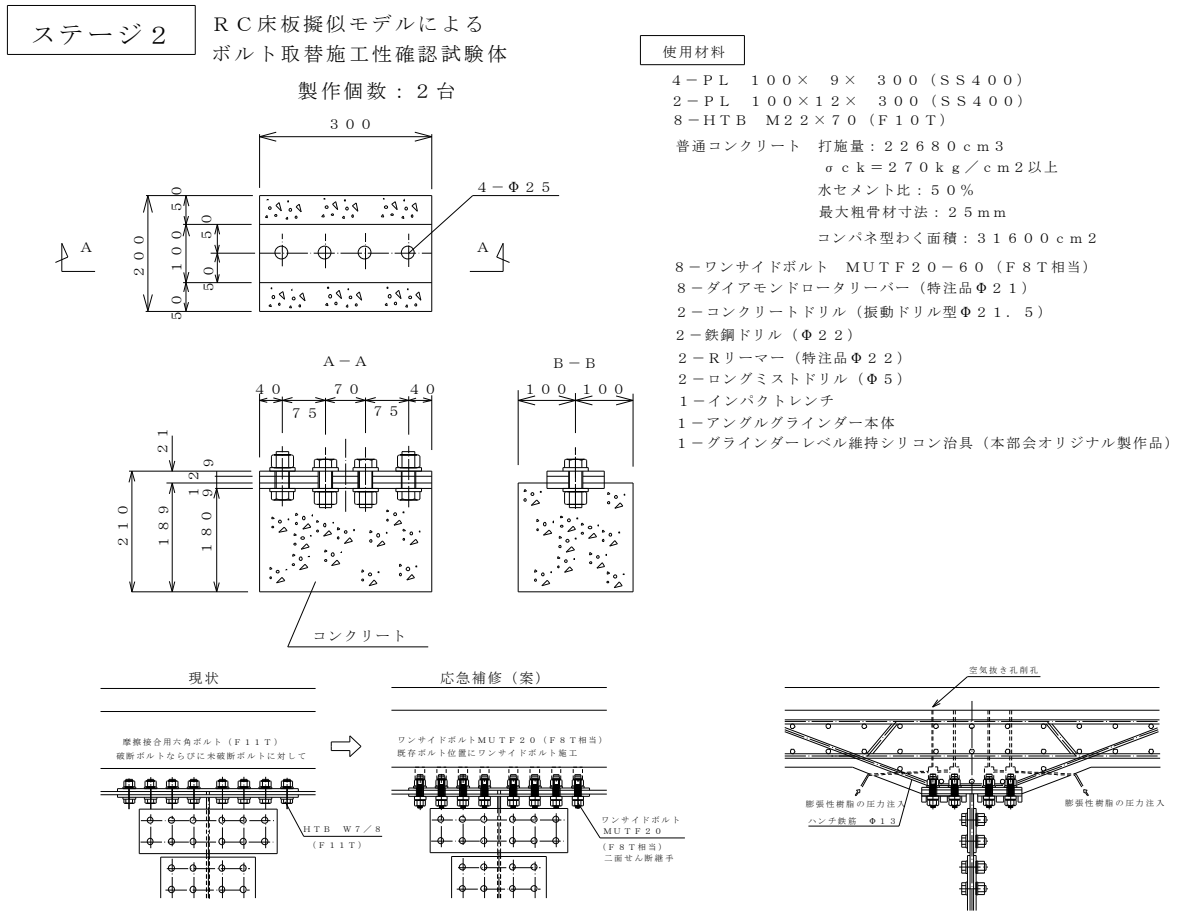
RC床版擬似モデルによるボルト取替え施工確認試験体図
